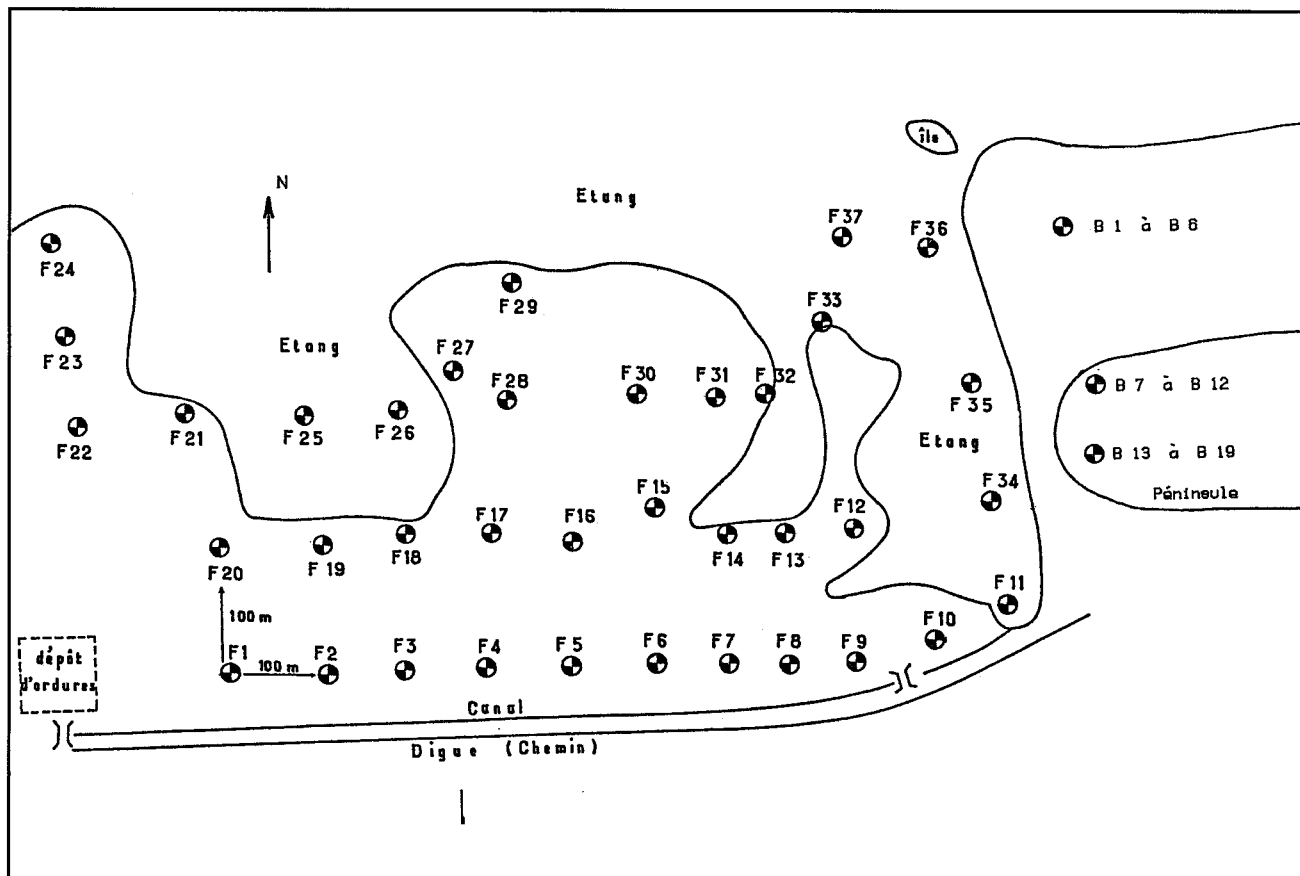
Implantation schématique des tranchées de reconnaissance Site III.
